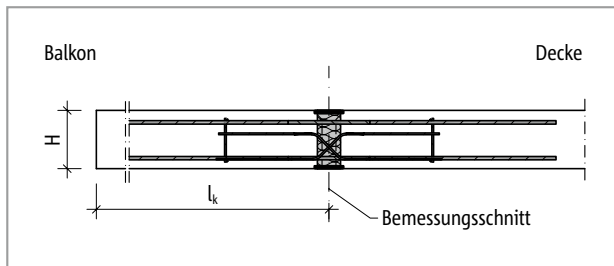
Schöck Isokorb® T Typ D: Statisches System
